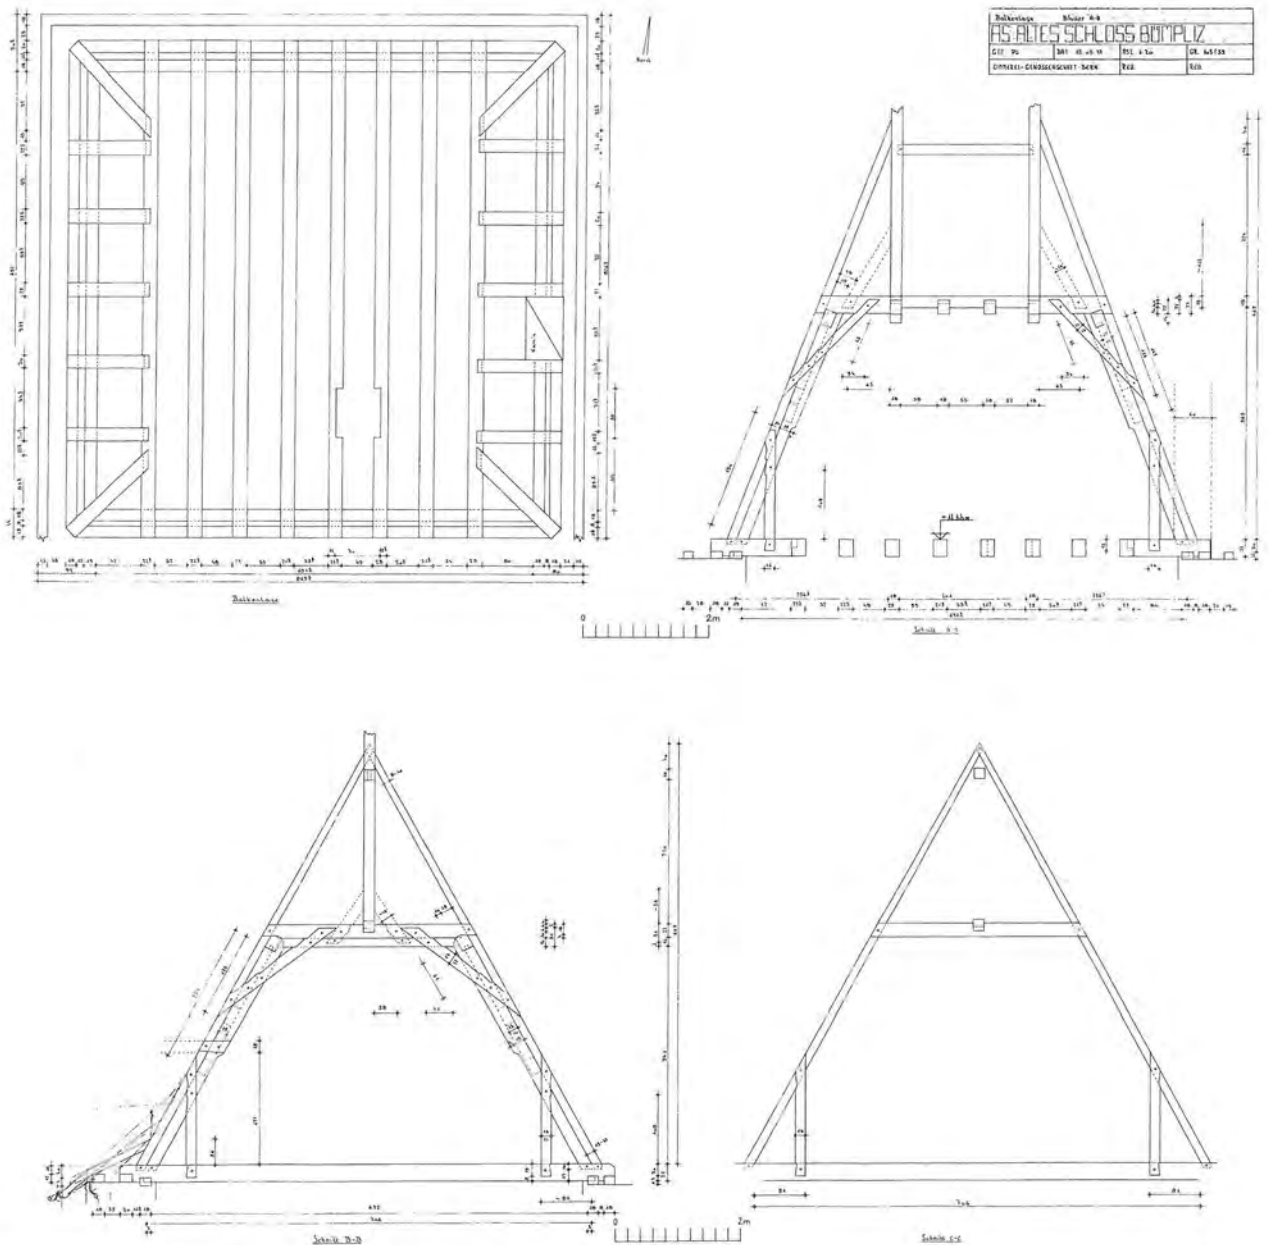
Torturm, Dachstuhl, oben: Grundriss der Balkenlage, Ansicht Stichbalken und Binderkonstruktion, unten: Ansicht Bundbalken und Binderkonstruktion, Bundbalken und Sparrenkonstruktion, 1977. Der Aufschiebling gehört zur Dachgestaltung des 19. Jahrhunderts. Gepunktet: Rekonstruktionsversuche zum spätgotischen Aufschiebling.
